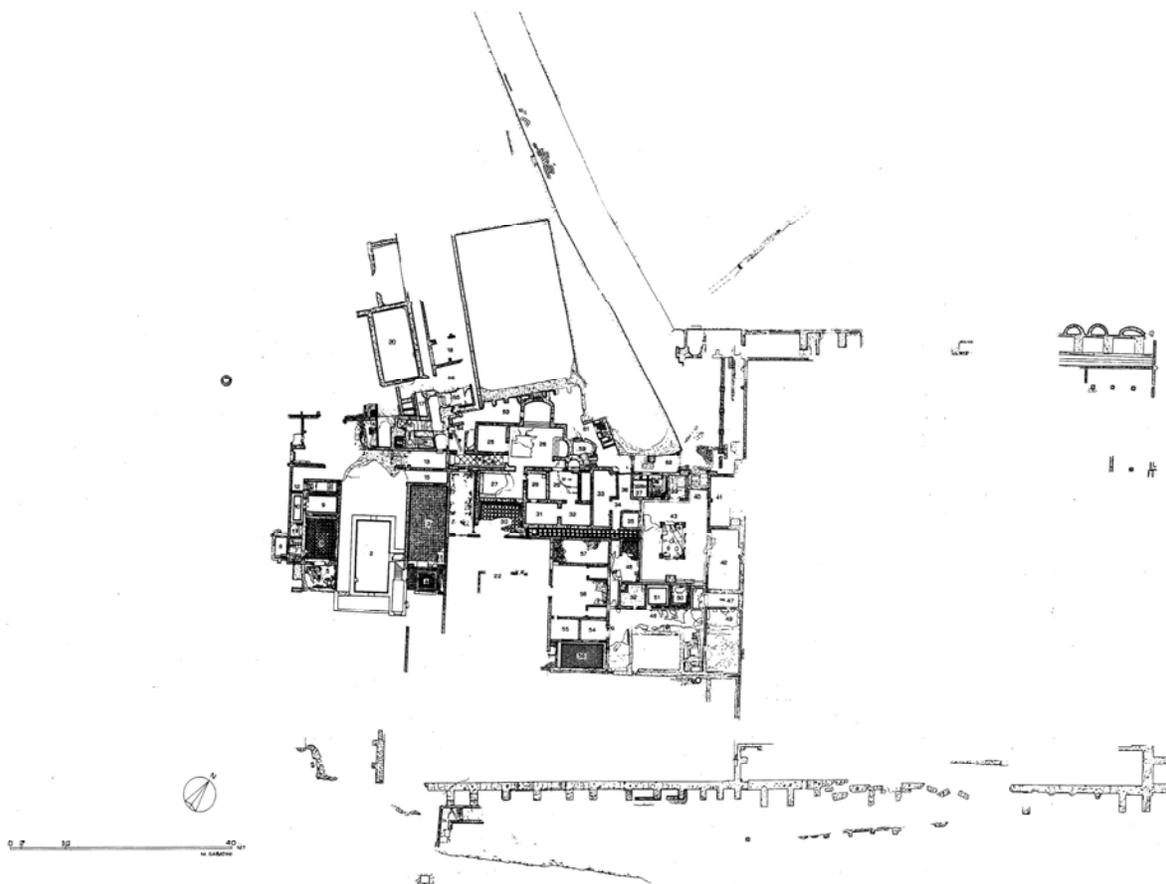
Villa de Livia Planta (levantamiento de Sabatini).
